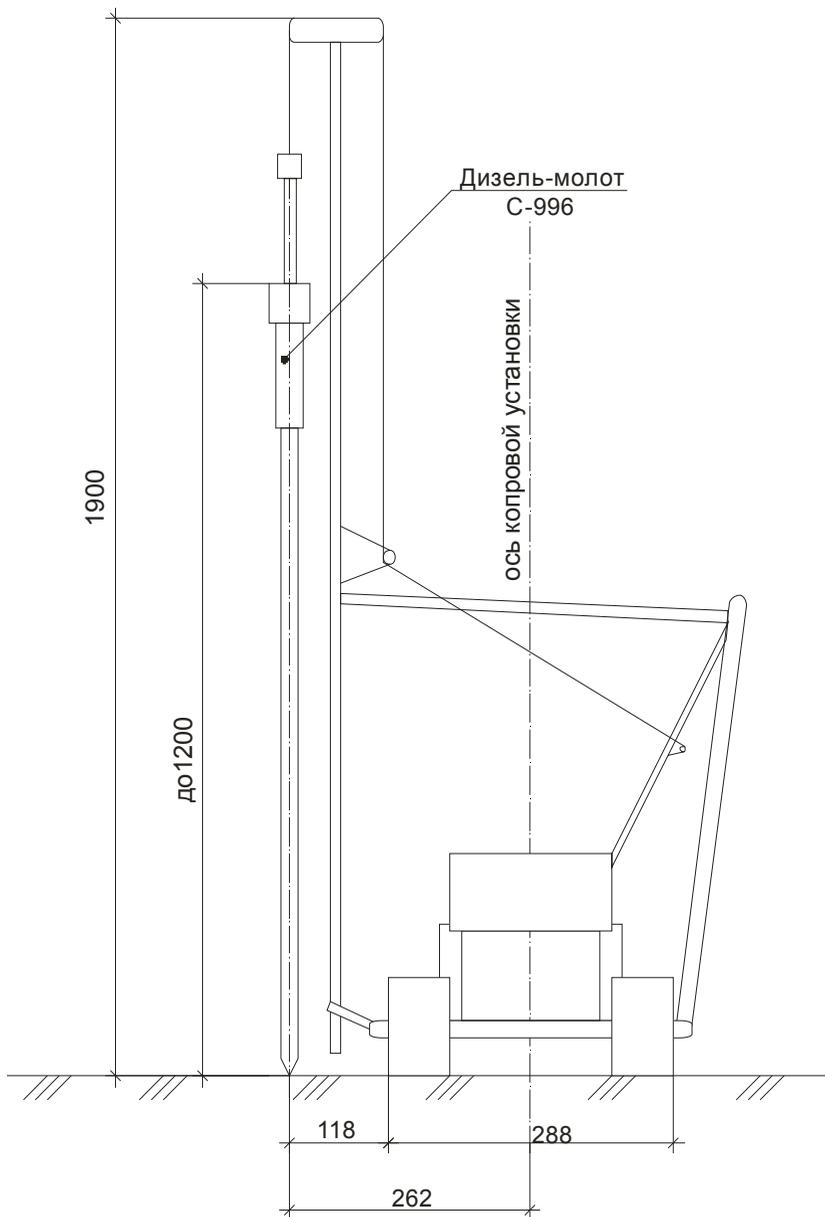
Общий вид сваебойной установки СП-49А (Б)
